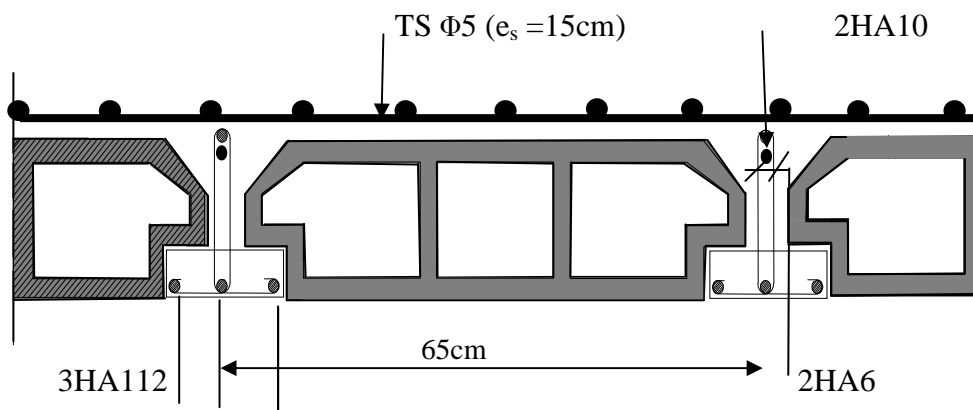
Plan de ferrailage du plancher en corps creux.
